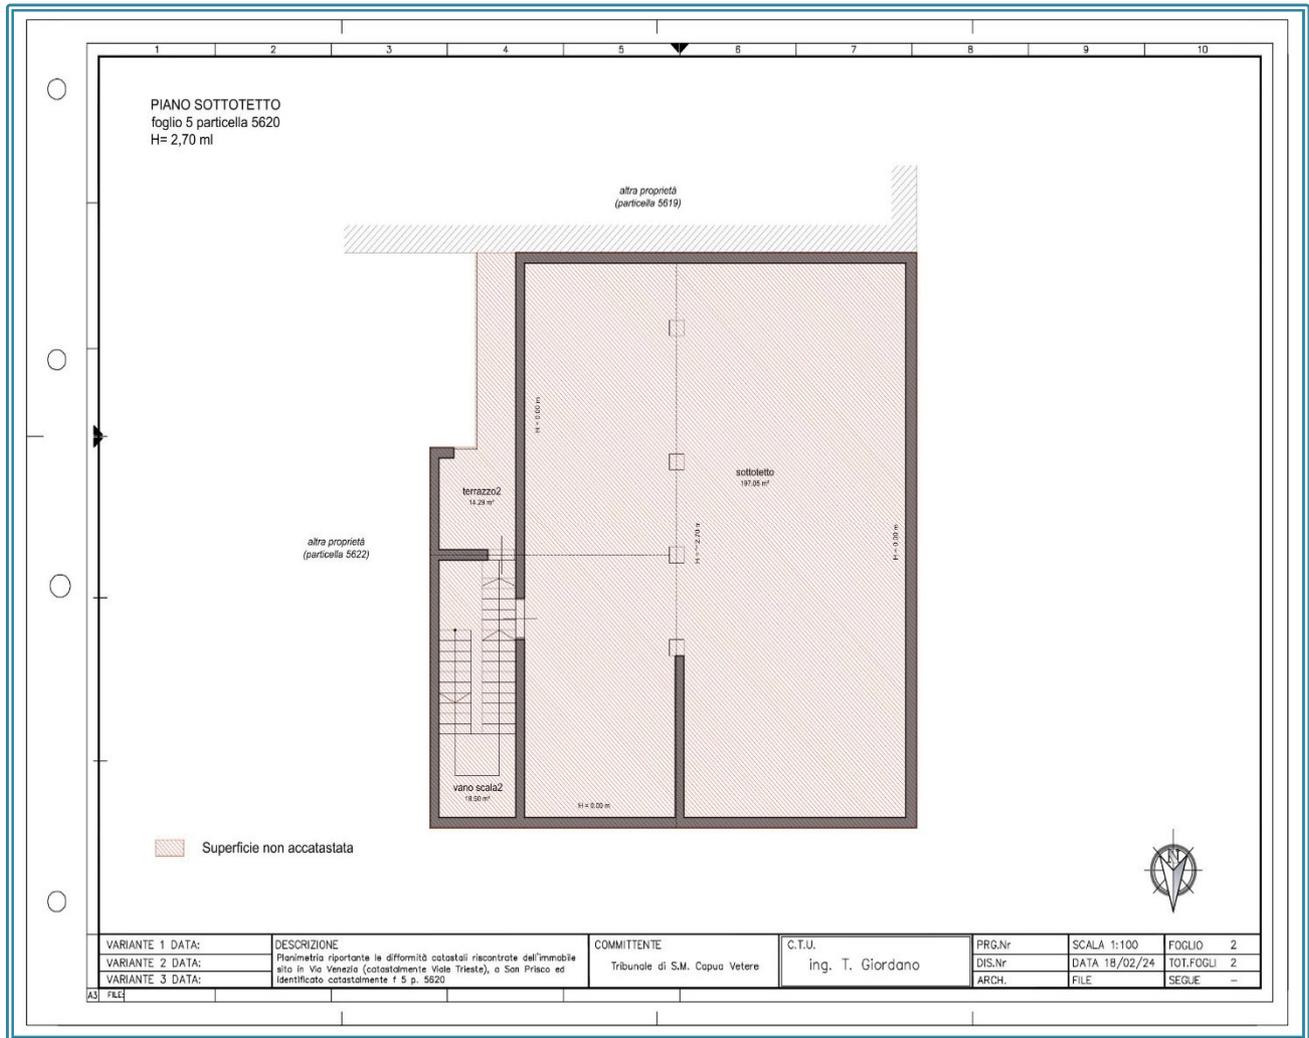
Schema difformità LOTTO 13 (Piano Sottotetto)
